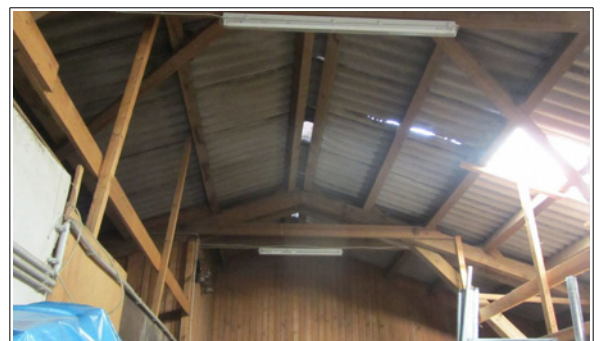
Dachstuhl des Betriebshofes mit teils erodiertem Wellblechdach
